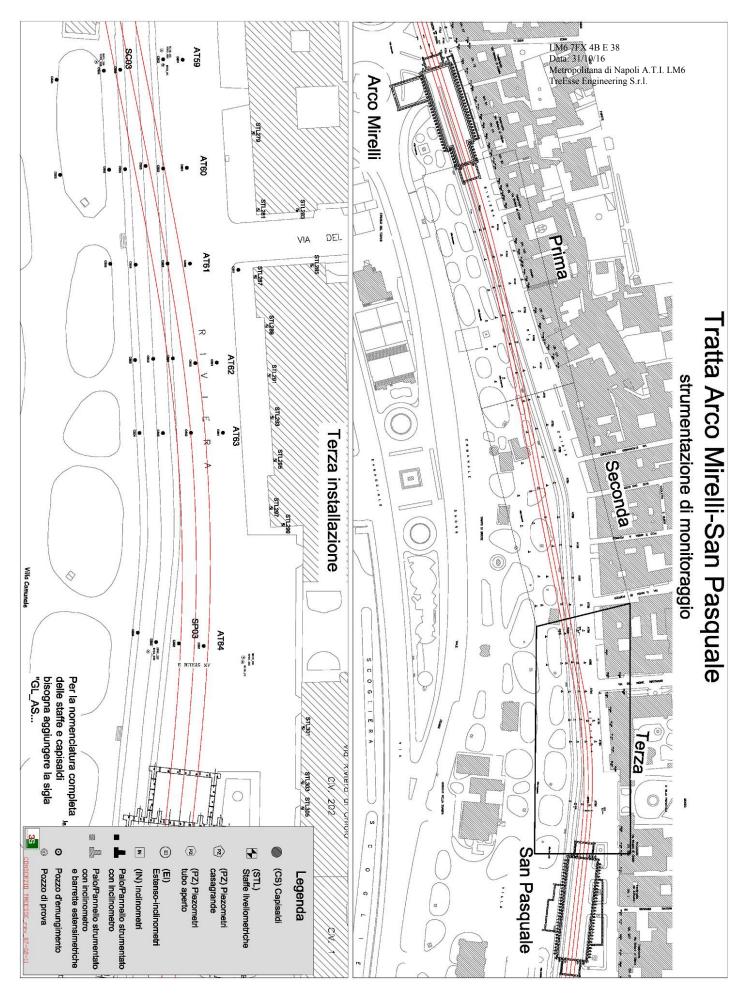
Planimetria tratta Arco Mirelli-SanPasquale, raffigurante la disposizione della terza installazione della strumentazione di monitoraggio
